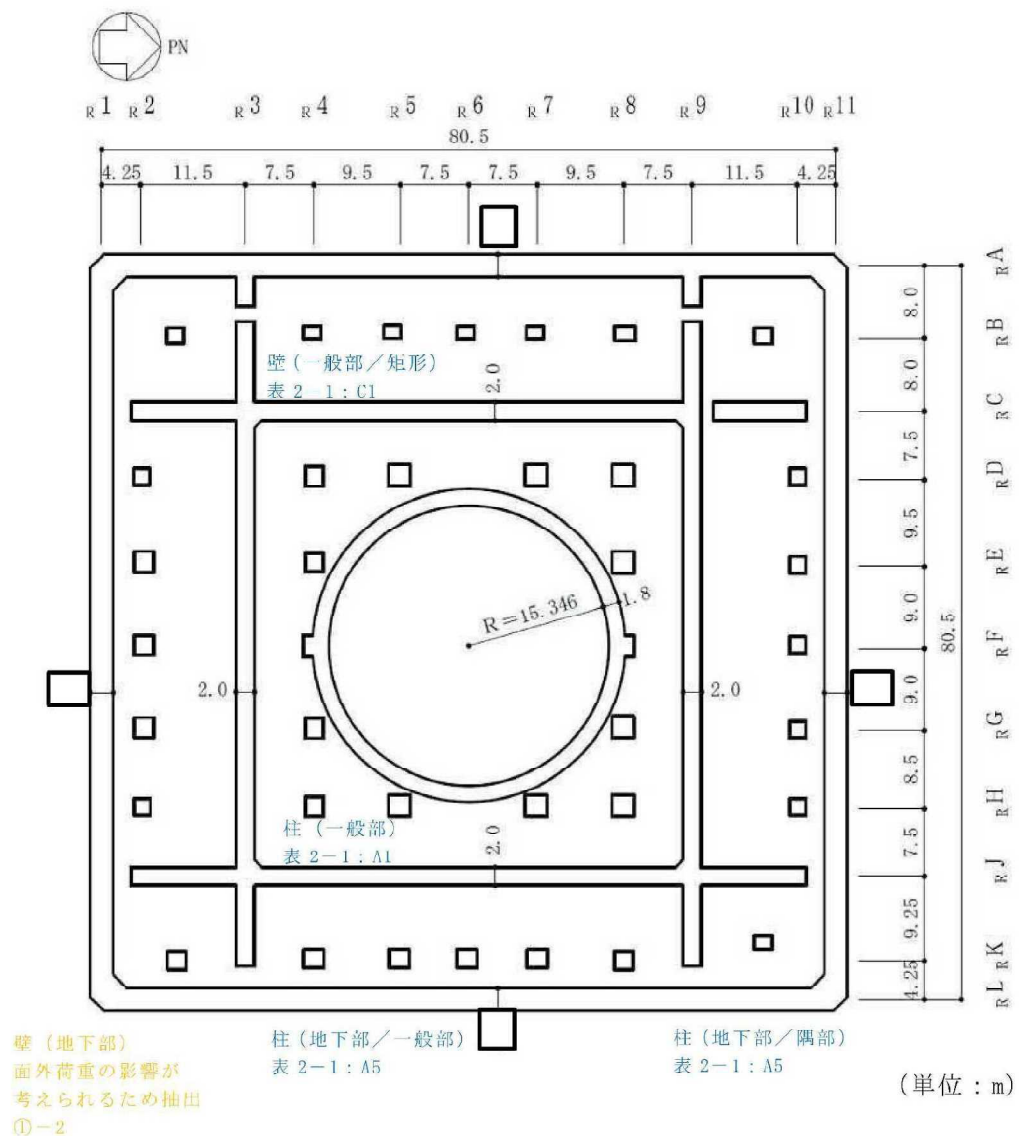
5号機原子炉建屋の概略平面図 (B4F, T.M.S.L. -17.5m) (1/9)
